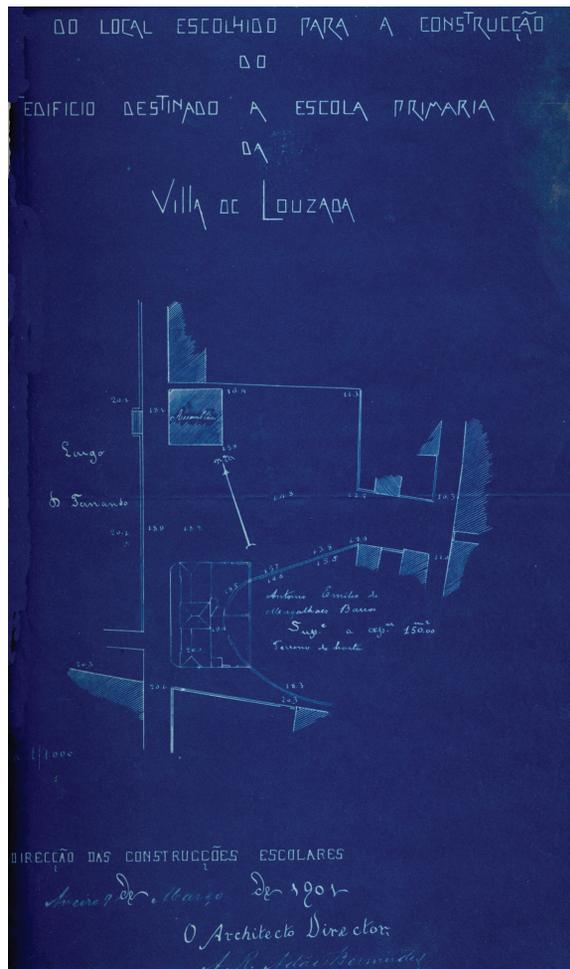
Planta com a localização e implantação do edificio escolar de Silvares apenas ao officio da Direcção das Construções Escolares, datado de 21 de Março de 1901. AML.
